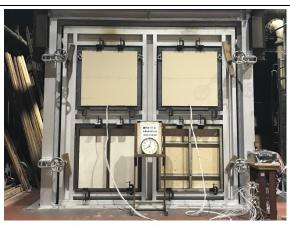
試験体 1-1,1-2 非加熱面・放冷終了時(480分)
